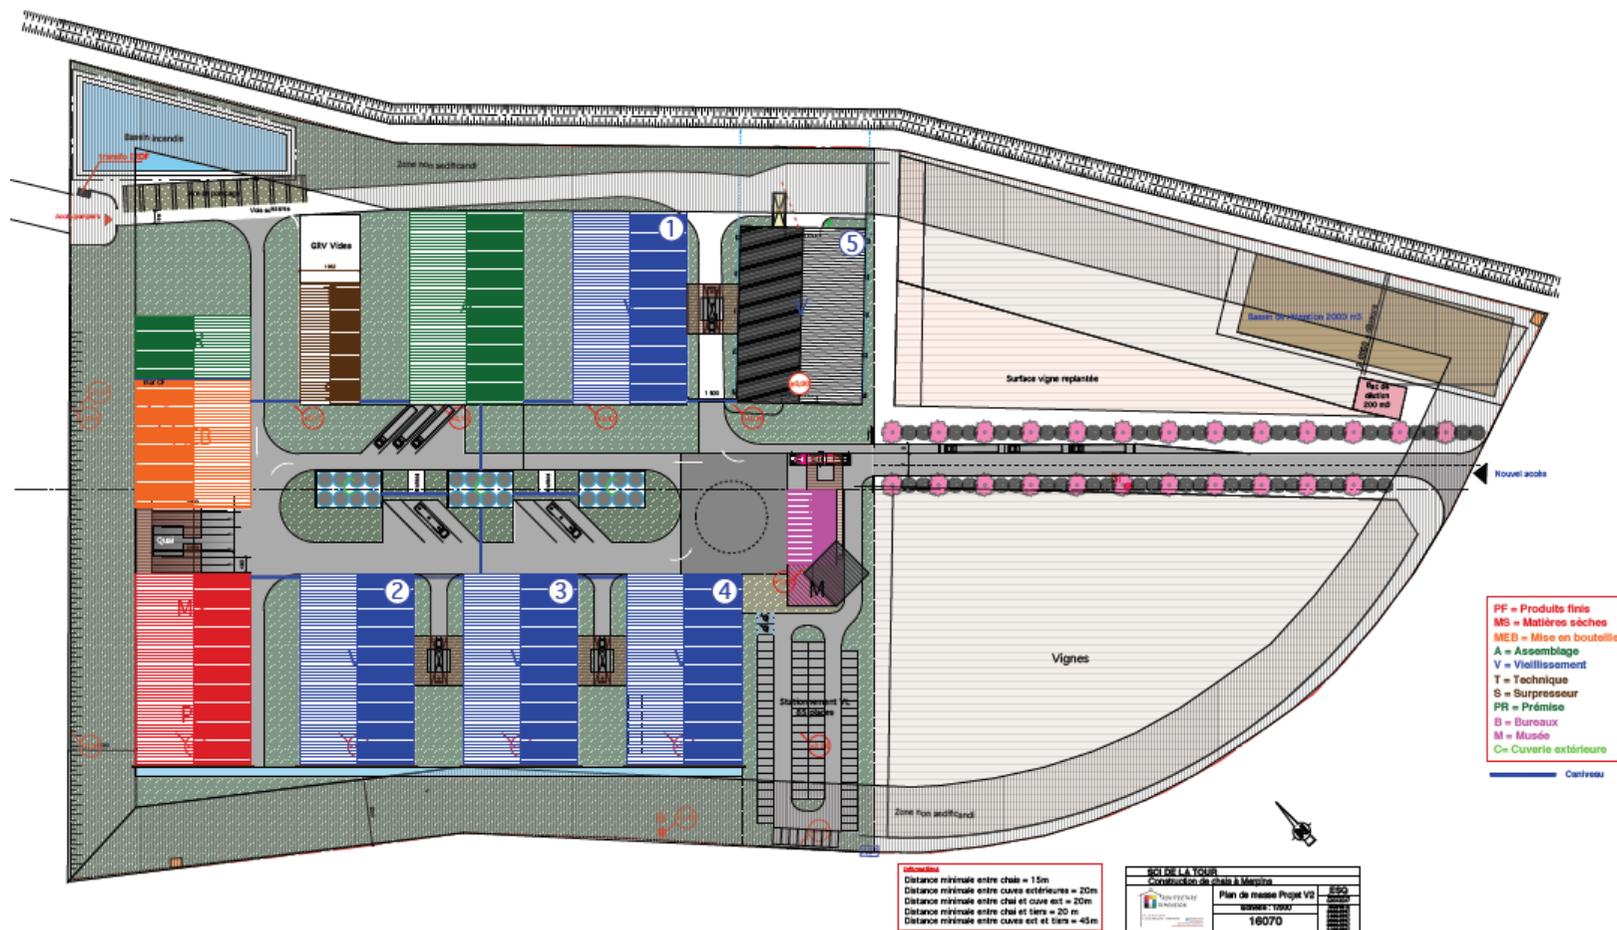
Plan de masse du 3 avril 2017 (source : Architecture Dimension)
